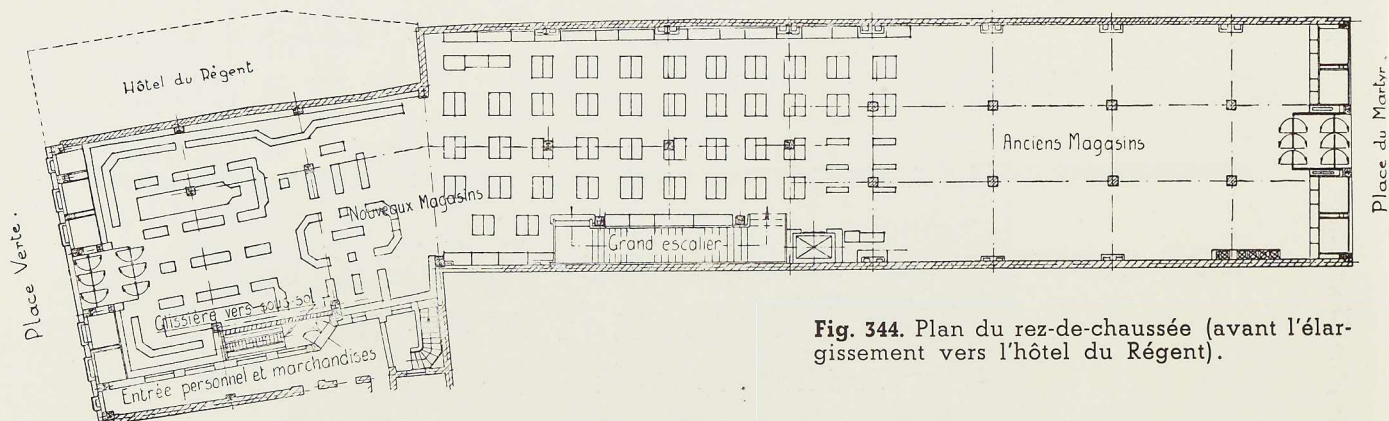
Plan du rez-de-chaussée (avant l'élargissement vers l'hôtel du Régent).
